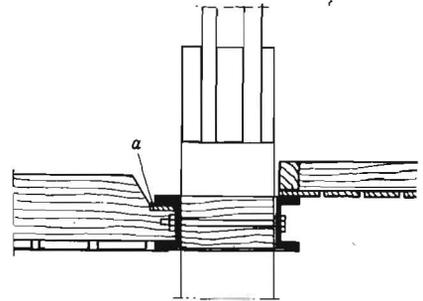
Verschiedene Lagerung bei den beiden Ausführungsformen der Deckenisolierung. Links: Decke nach Bild 3, rechts: Decke nach Bild 4, a abgenageltes Keilpaar
